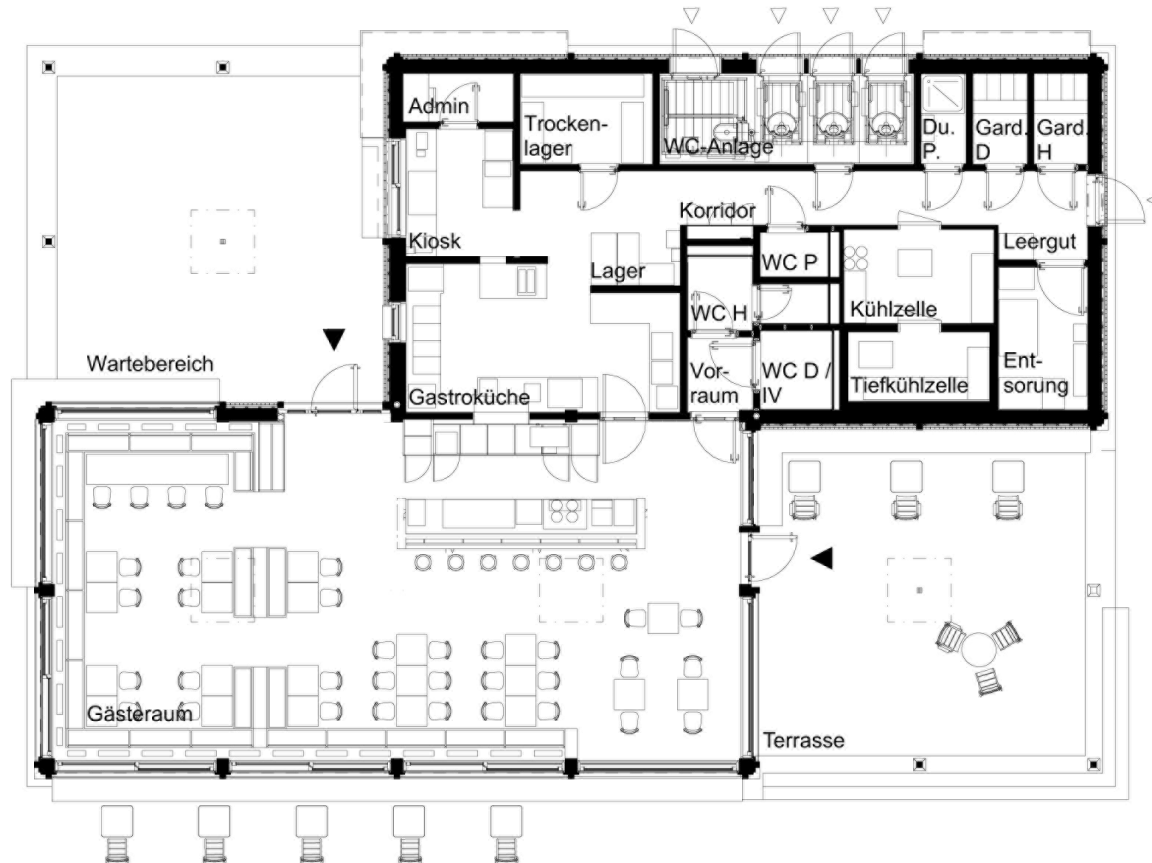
Grundrissplan des Seerestaurants «Schiffände»
